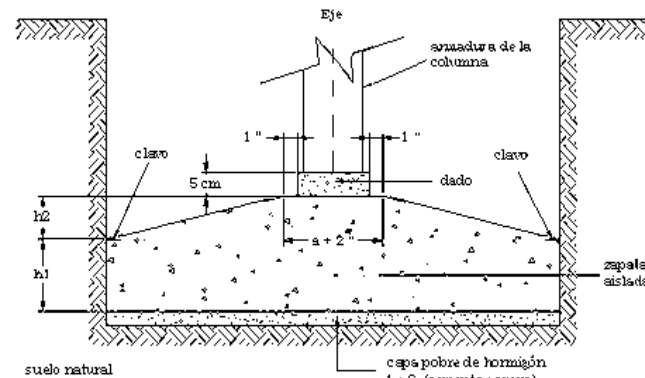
cimentación de zapata aislada con escarpio de concreto armado, imagen capturada por Francisco Reyes
